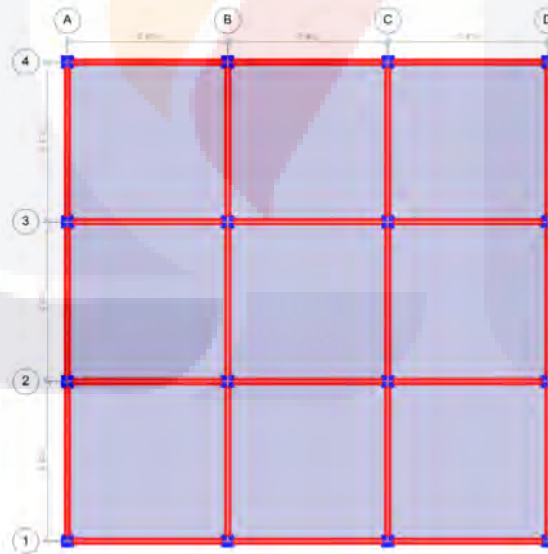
Vista en planta del edificio. Las trabes se identifican en color rojo y las columnas en color azul.
